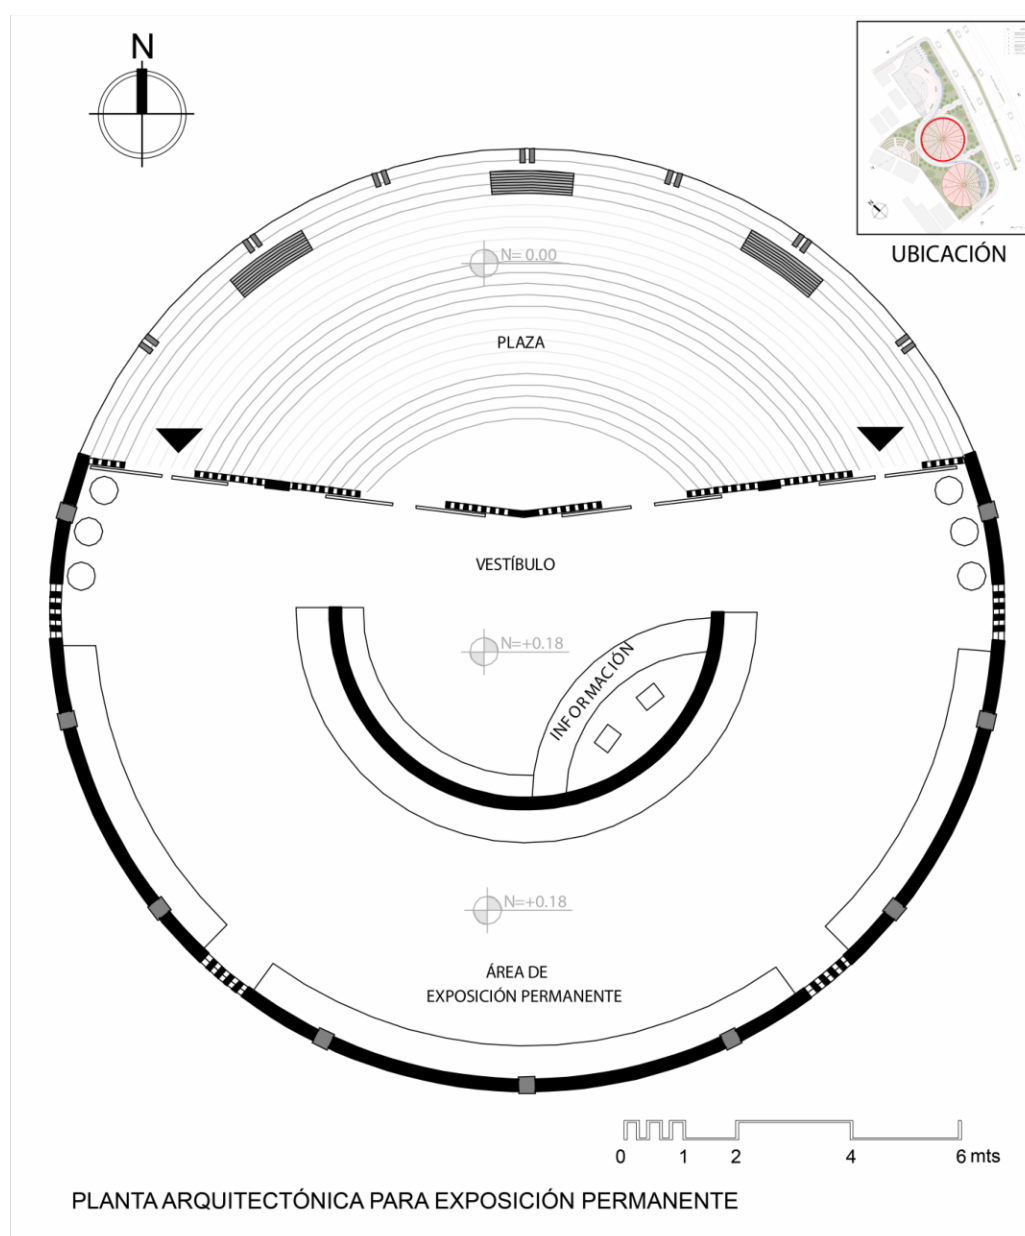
Planta arquitectónica del bloque 1 de exposición permanente.
